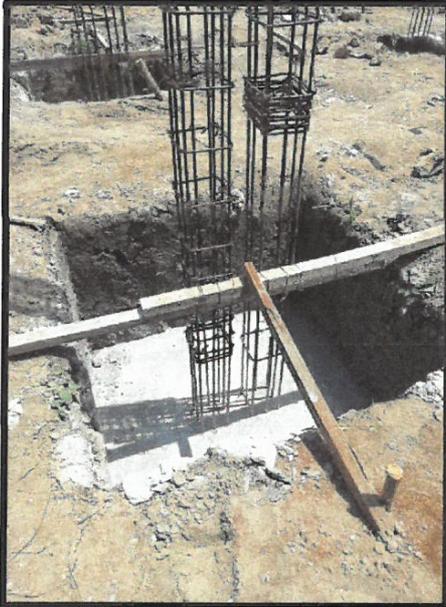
VACIADO DE ZAPATA Z-2 EN MODULO 2 EJE 9-B
